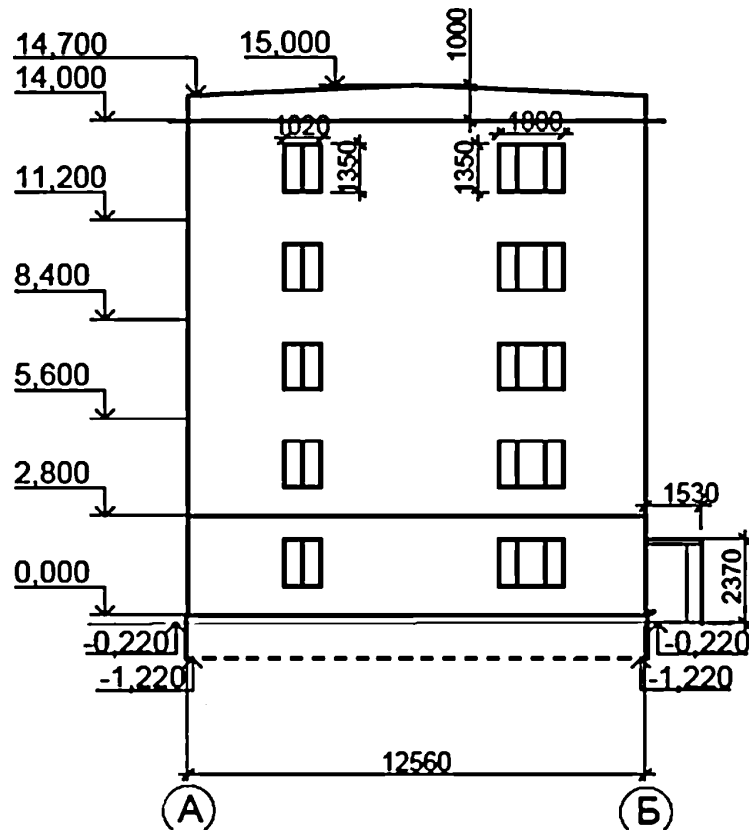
Фрагмент конструкції для утеплення фасадною теплоізоляцією
